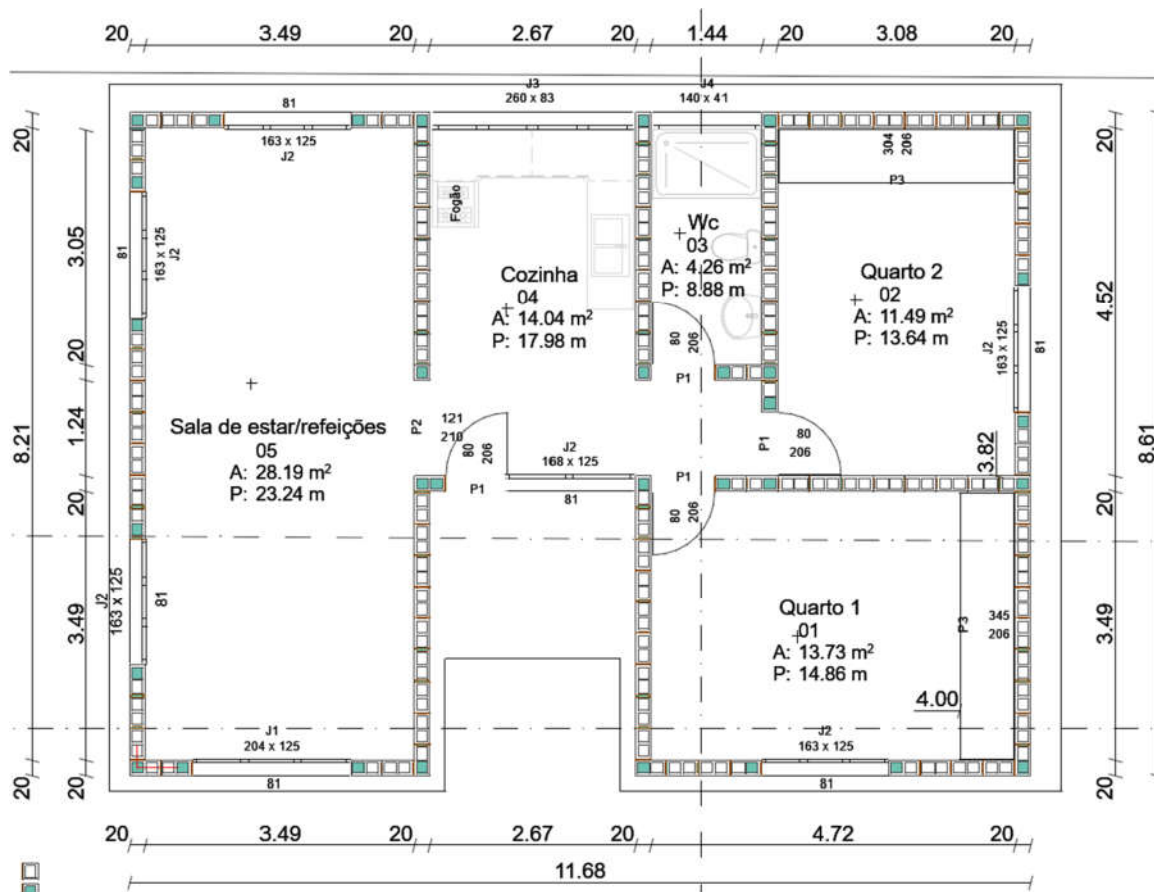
Estrutura em AE - Planta de piso, 1ª fiada.
